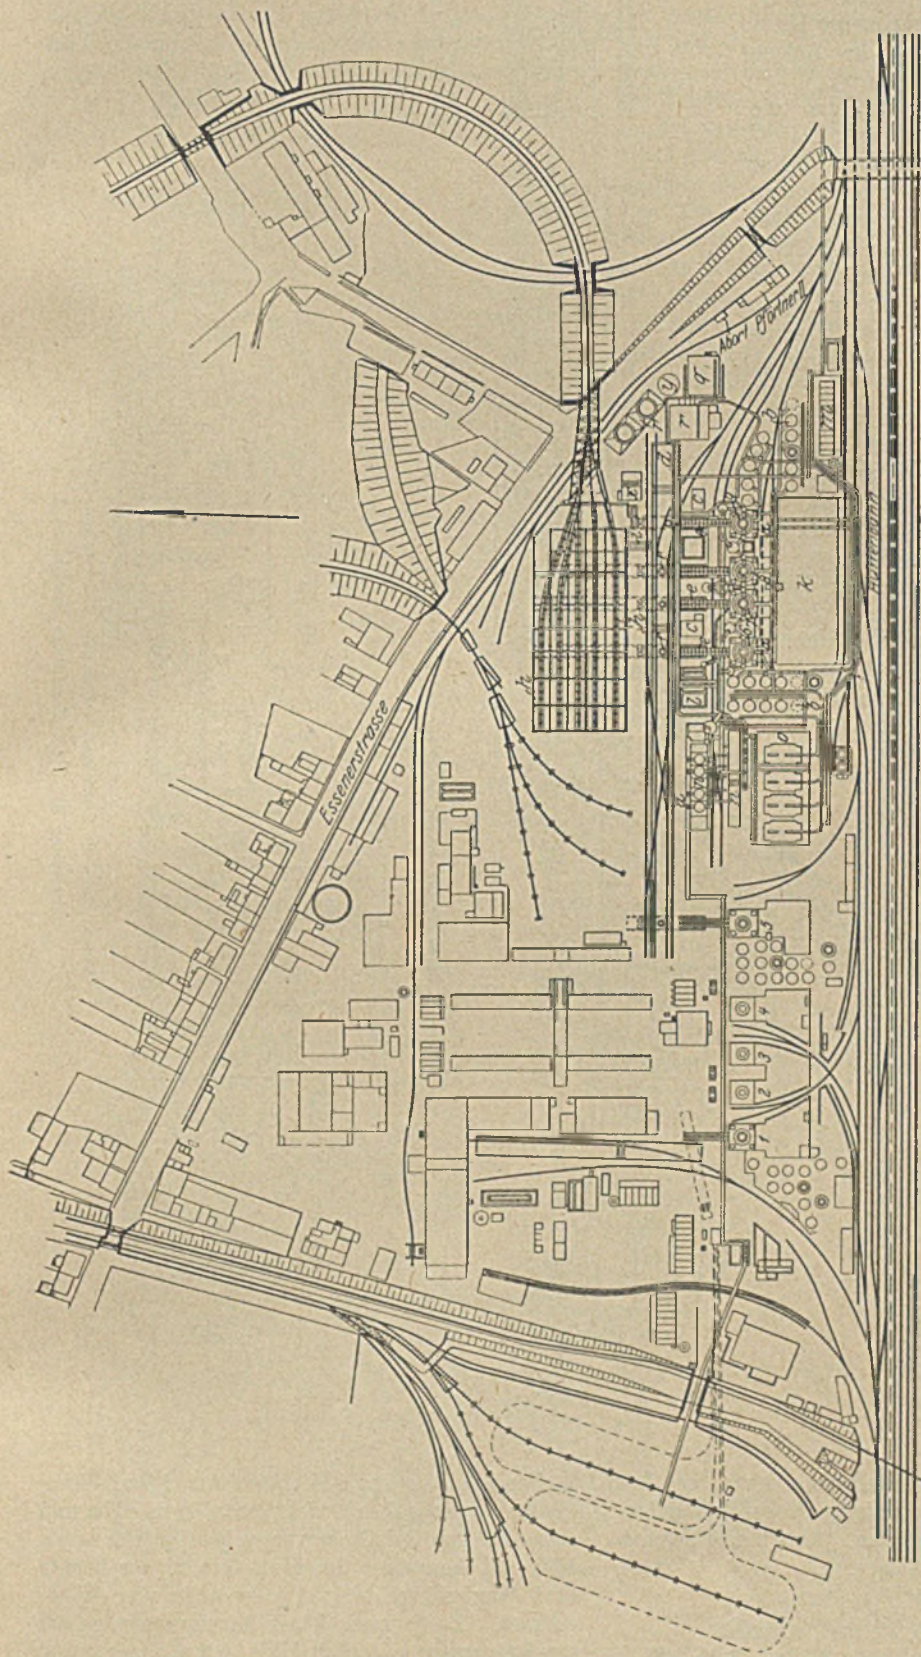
Lageplan der Eisenhütte I mit dem bisher umgebauten Teil, umfassend die Hochöfen 6 bis 9 nebst Zubehör, und dem alten Teil mit den noch in Betrieb befindlichen Hochöfen 1 bis 5 nebst Zubehör.
